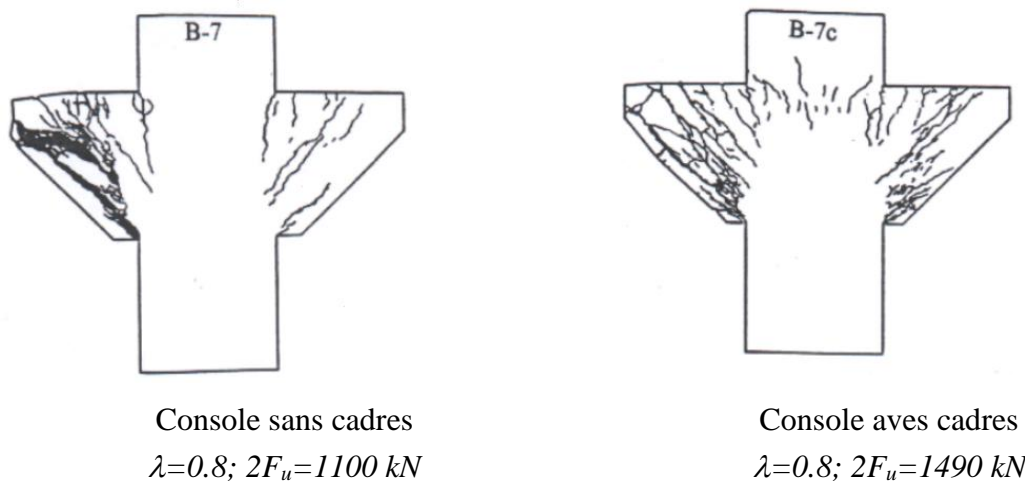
Fissuration de consoles avec et sans cadres horizontaux ; selon [ROB 69]
